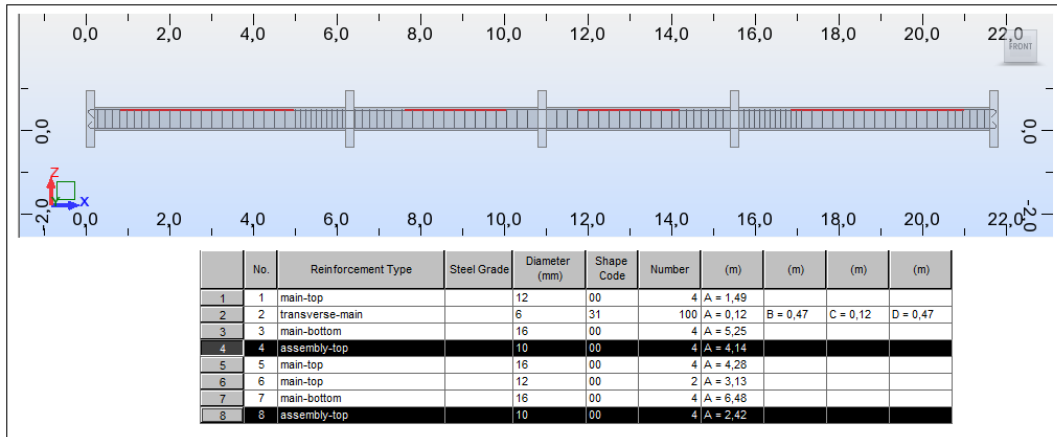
Porta-estribos com barras de 10mm - viga V1
